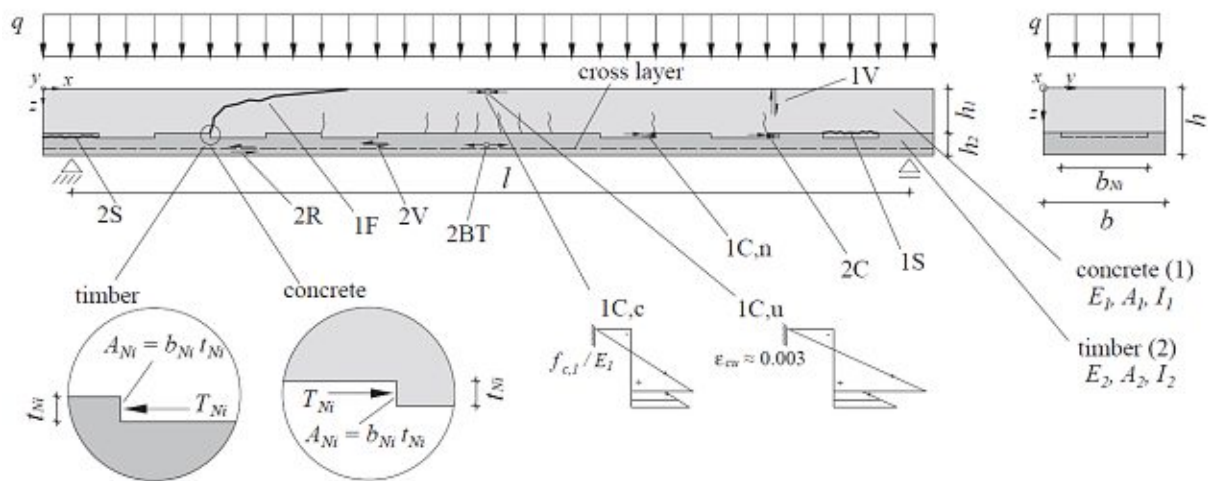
Mögliche Versagensformen bei der LVL-Beton-Verbunddecke (ohne Vertikalbewehrung) [6]
